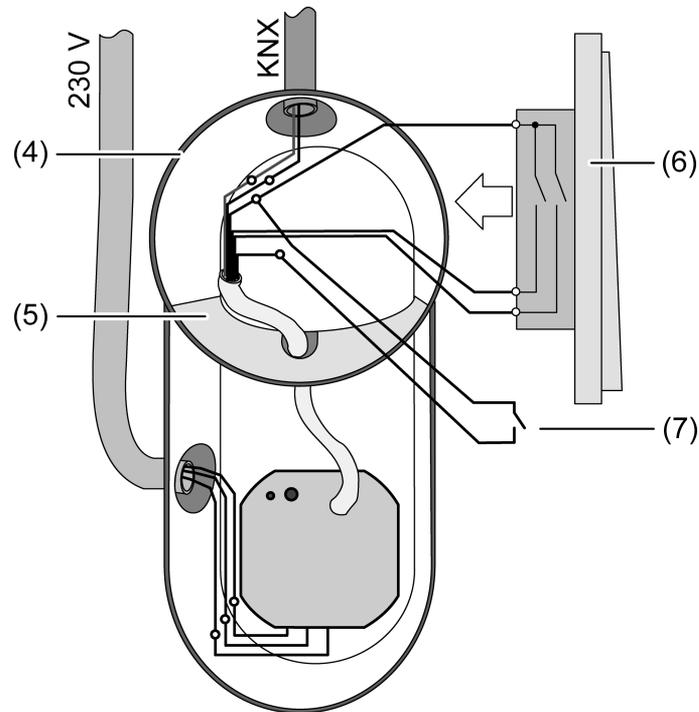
Montaje del aparato en una caja electrónica (ejemplo)
